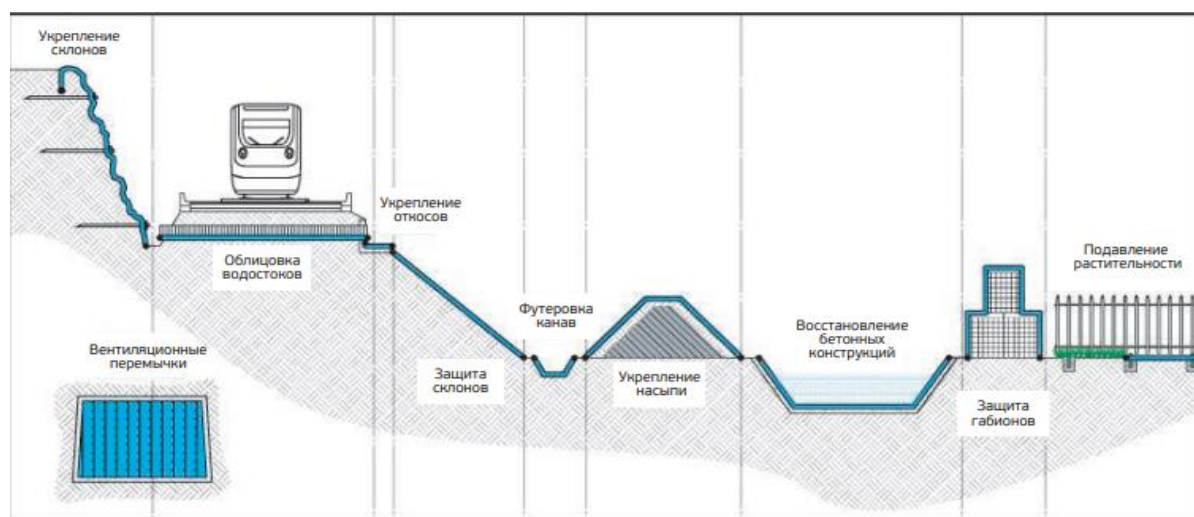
Применение бетонного полотна Concrete Canvas
